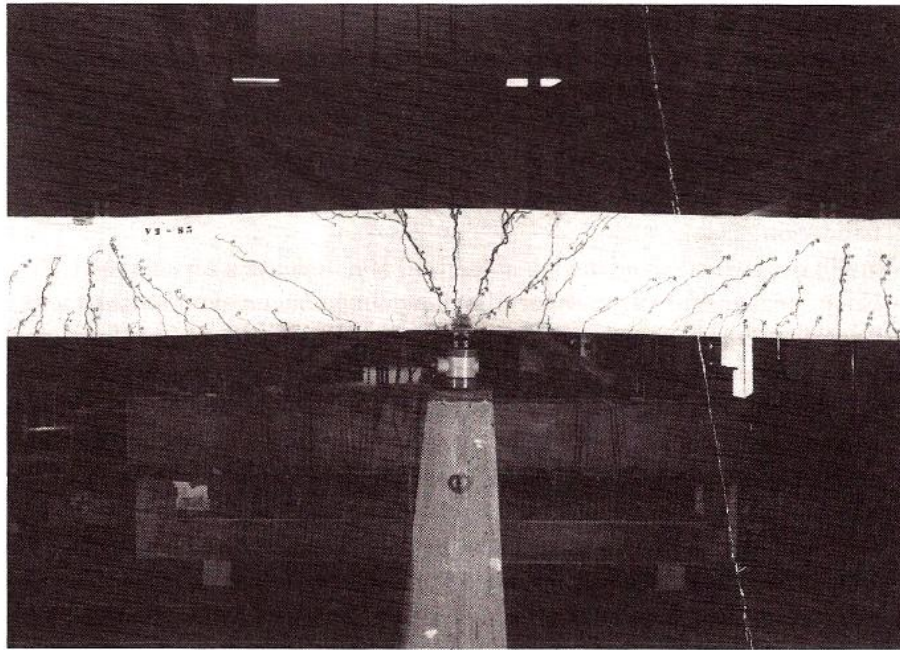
Control de la fisuración de una viga ensayada a flexión.
